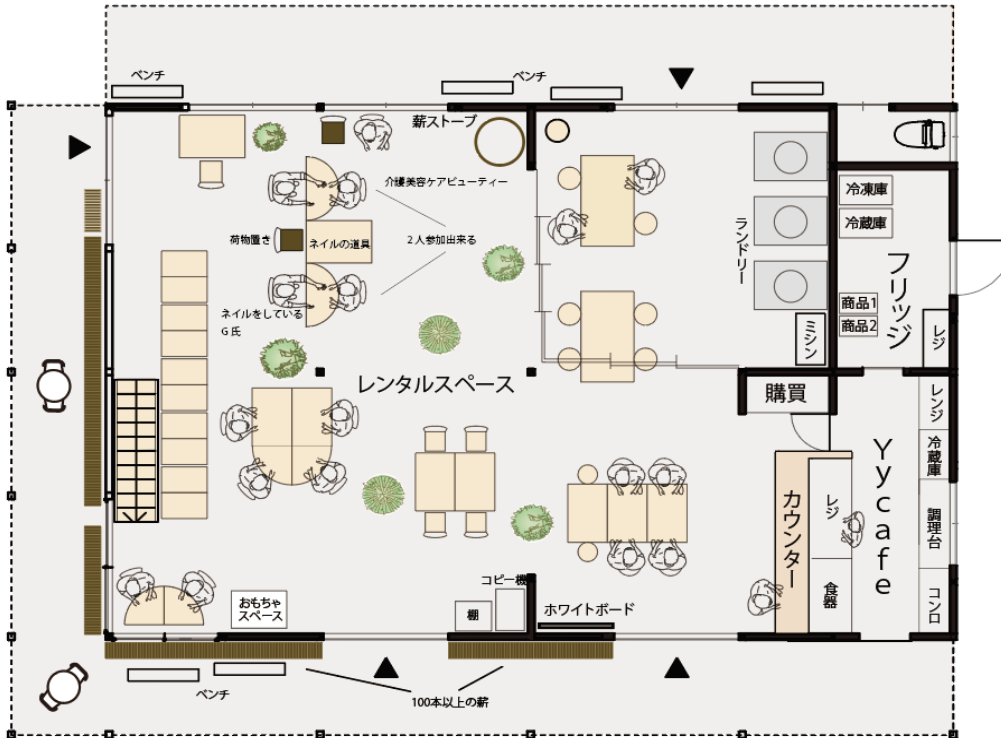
介護美容ケアビューティー体験会時の平面図
